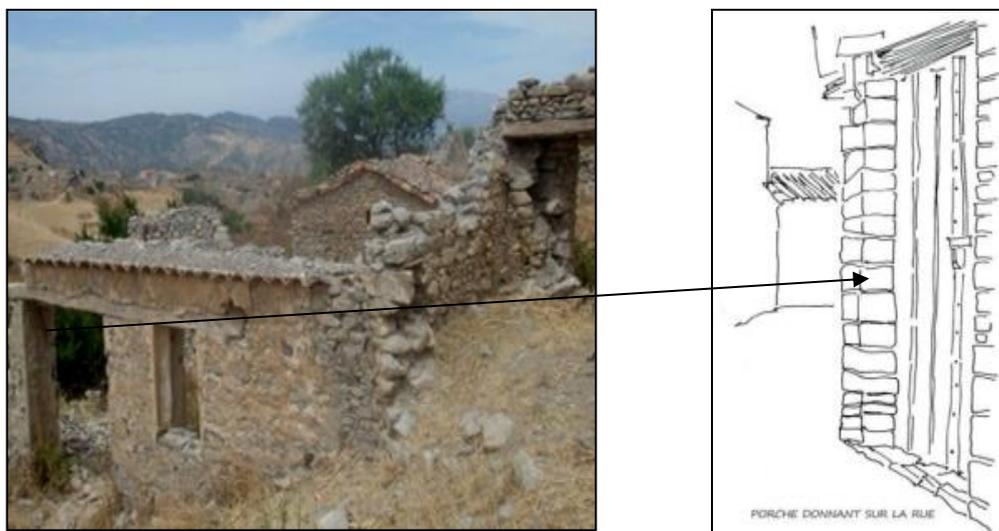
15 Photo et plan vertical d'un porche entrée d'une maison de la *Qalaa* des béni-Abbès à Béjaia (©Oulmas Mohand)
